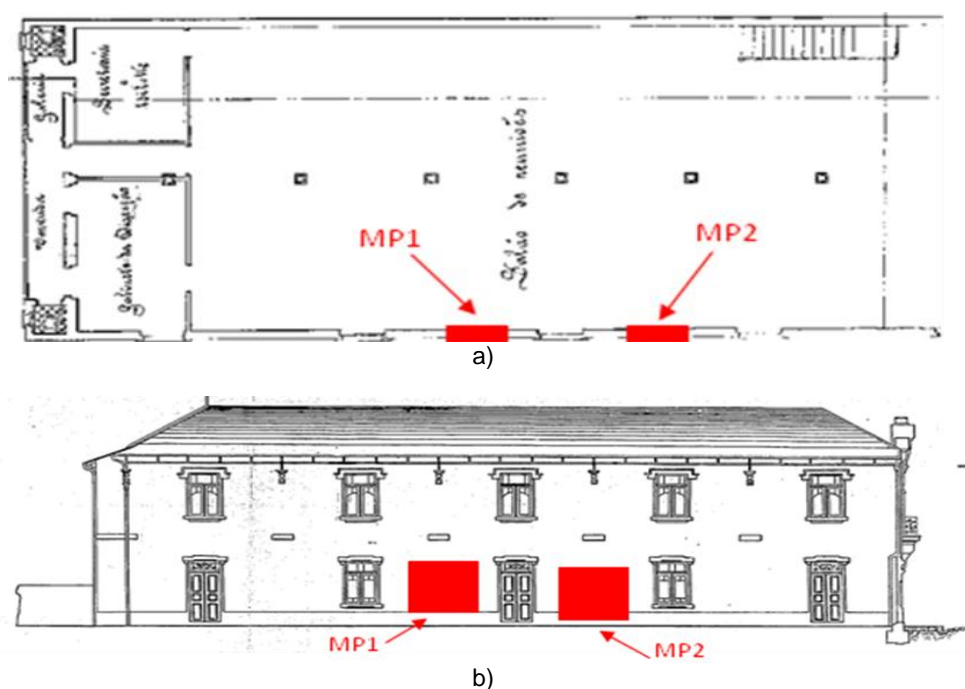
Localização do ensaio com macacos planos realizado no edifício de António Carneiro: a) vista em planta; b) vista em alçado.
